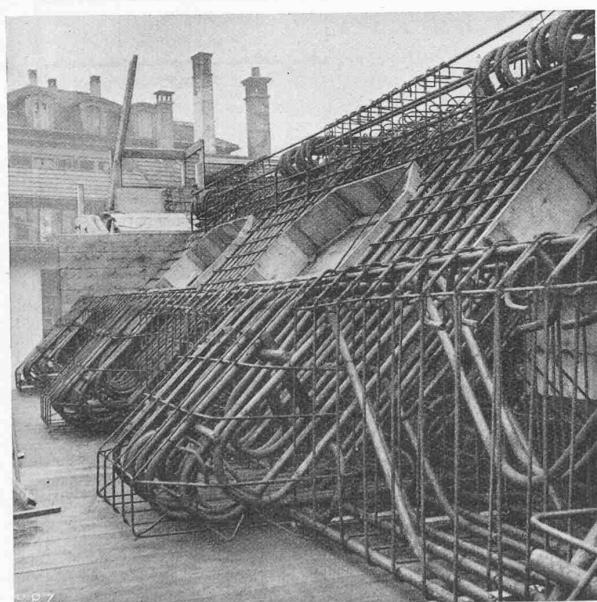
Bewehrung einer Gleitlager-Auflagerbank (Los 4)
